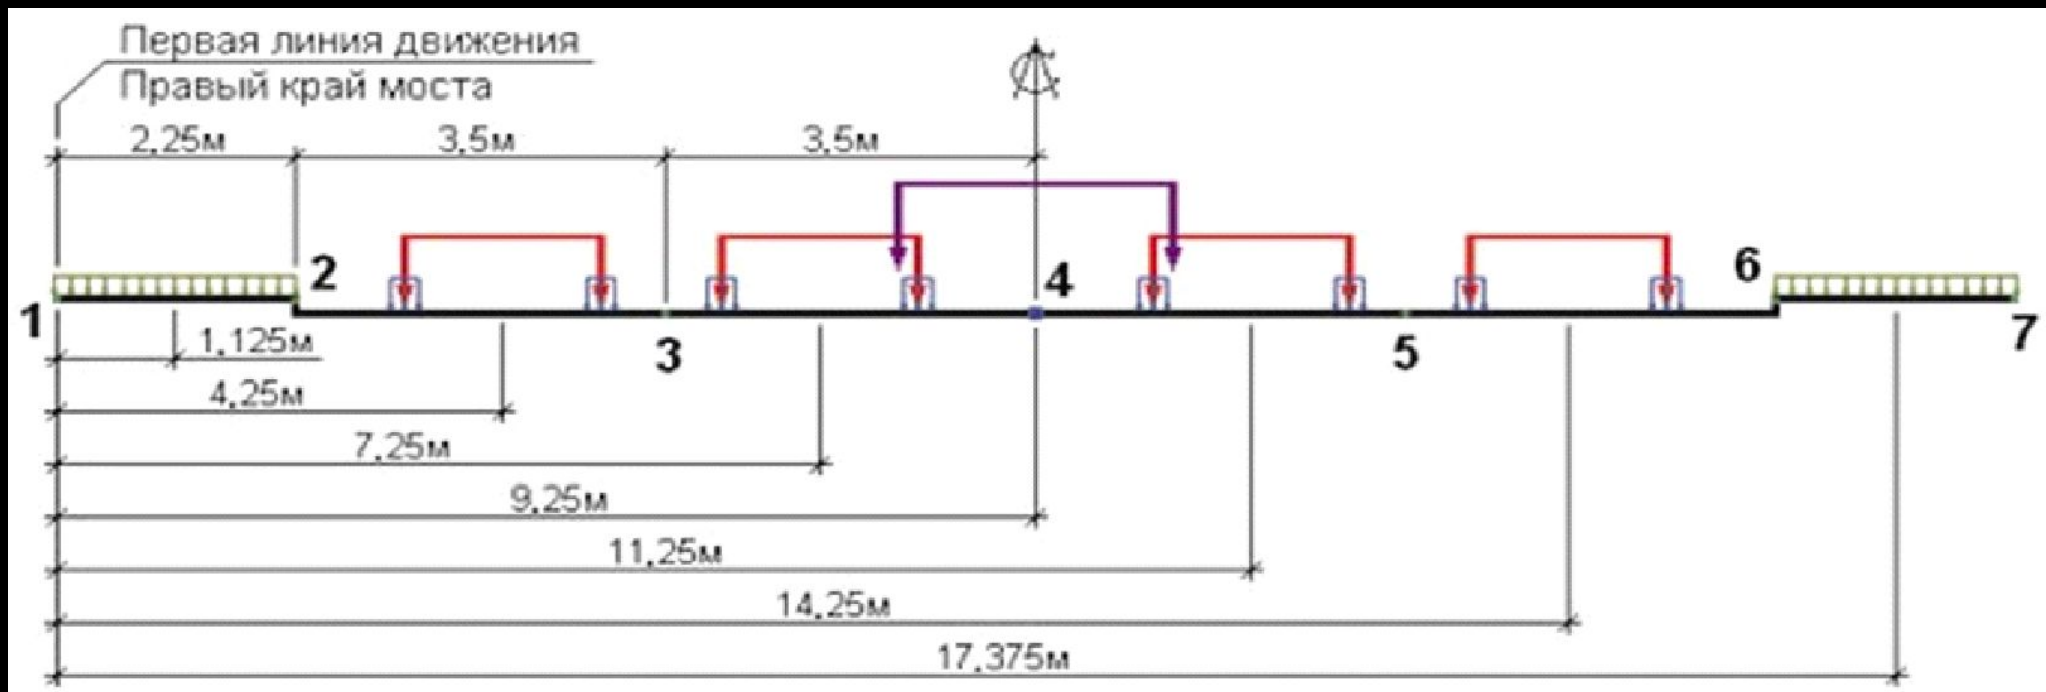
Привязки подвижных нагрузок поперек моста
